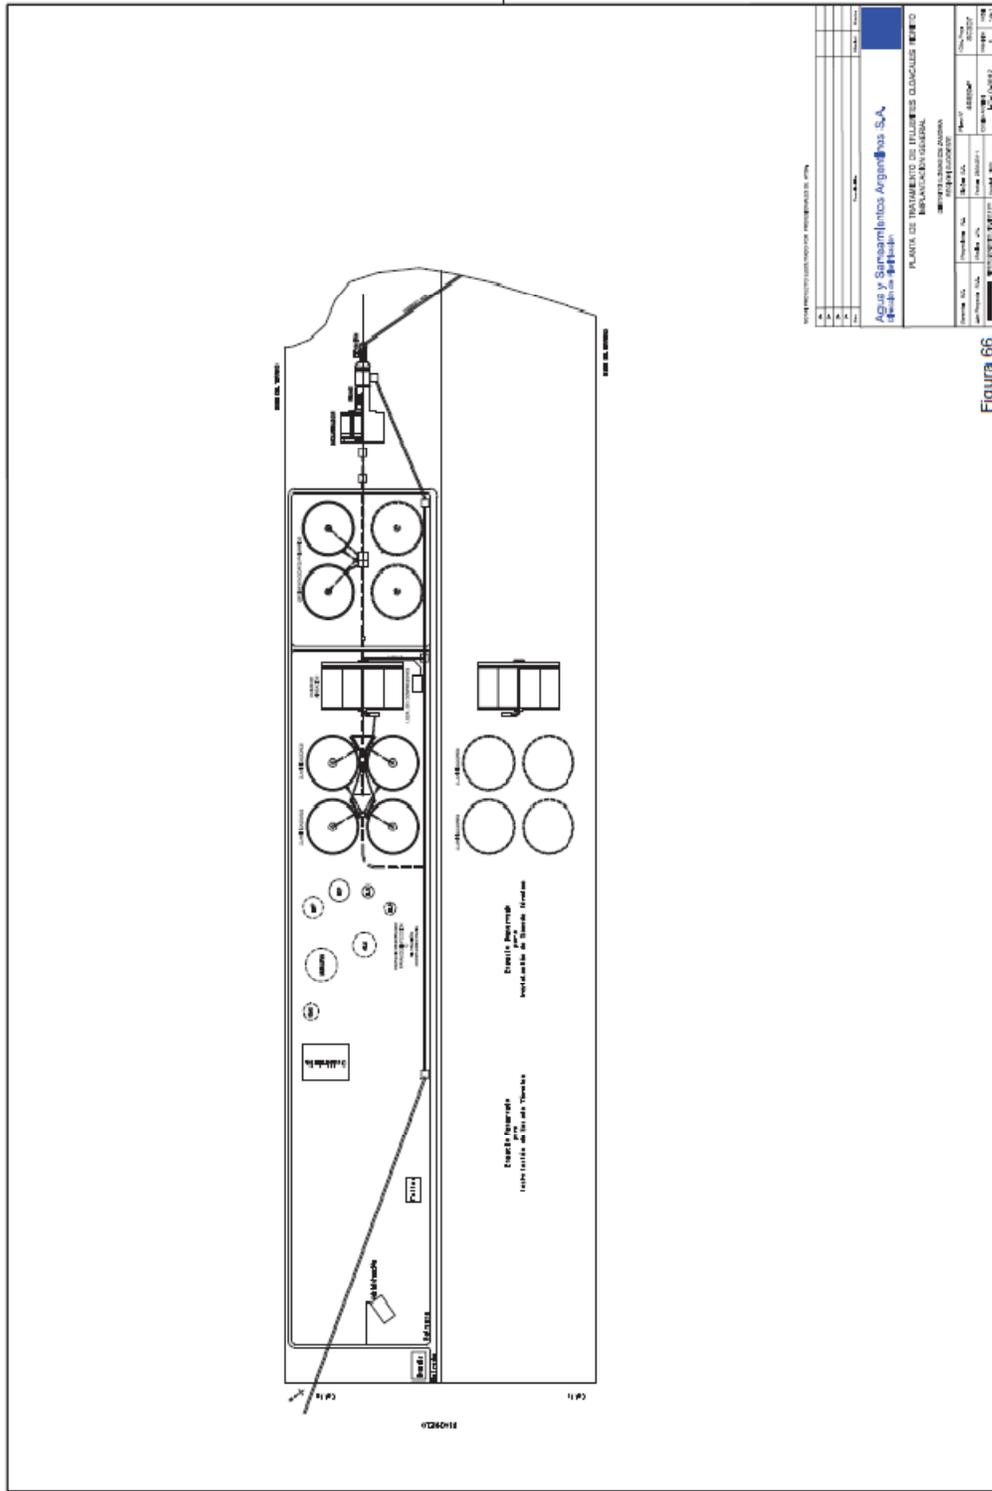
Planta de proceso de planta depuradora "Lanús"<sup>22</sup>.
